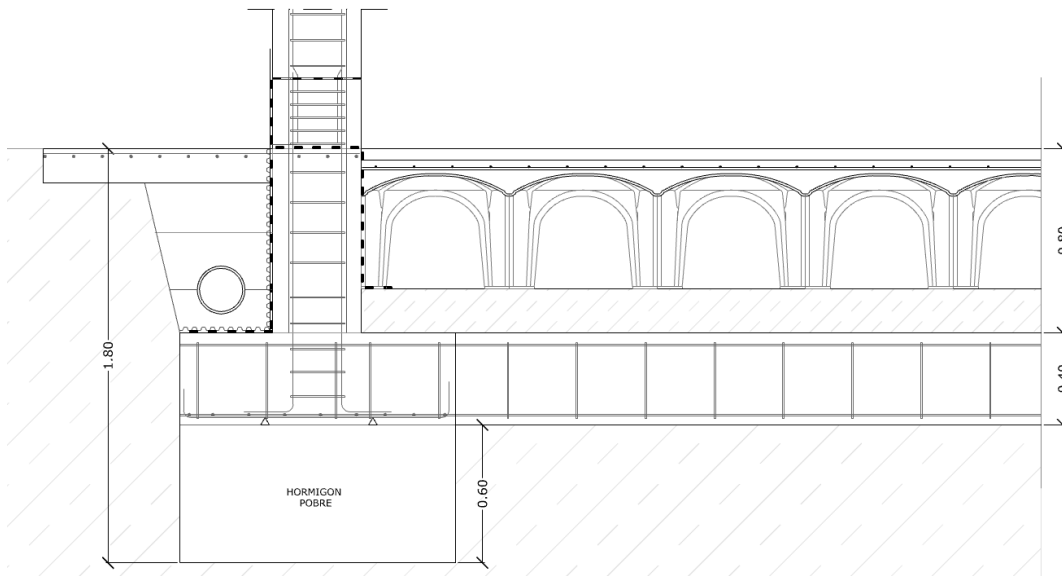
Detalle tipo de cimentación mediante pozo y forjado sanitario.
